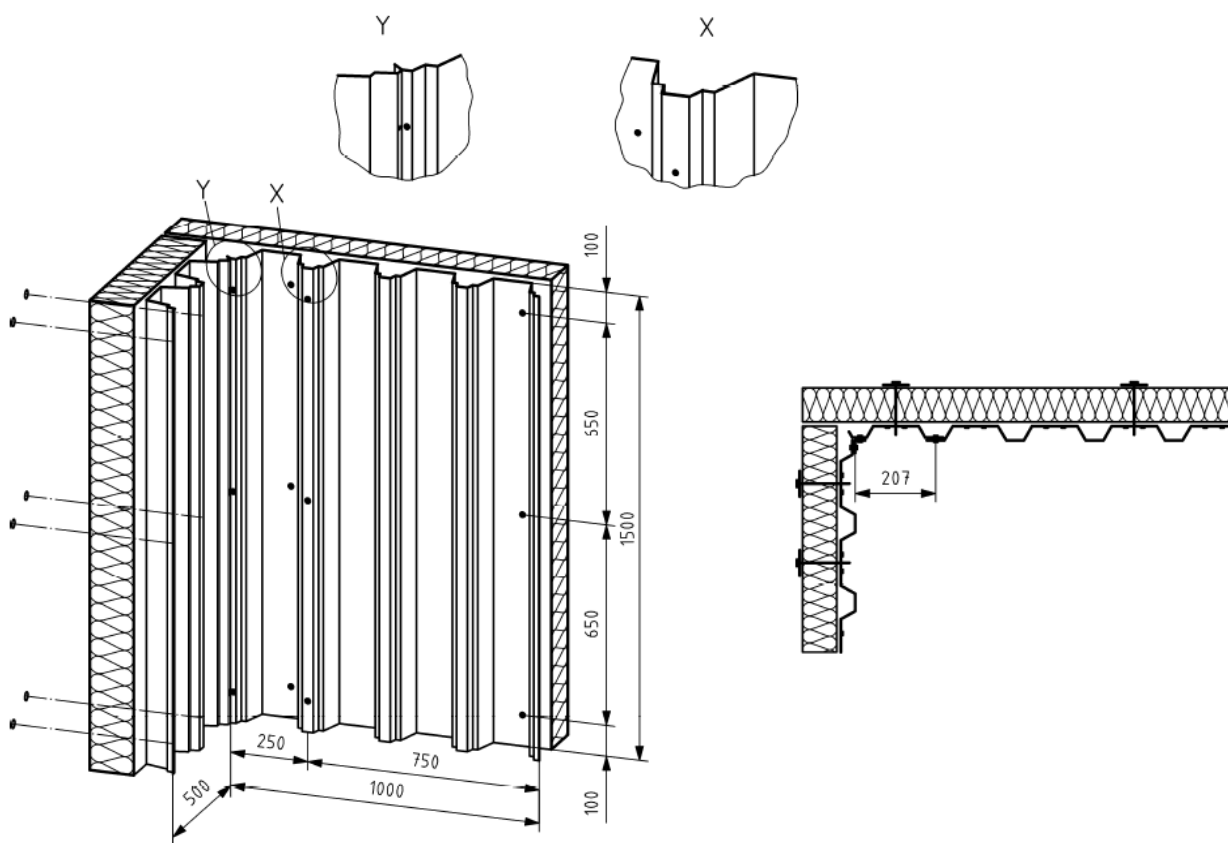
Fissaggio per lamiera in acciaio corrugata 34/207mm.
